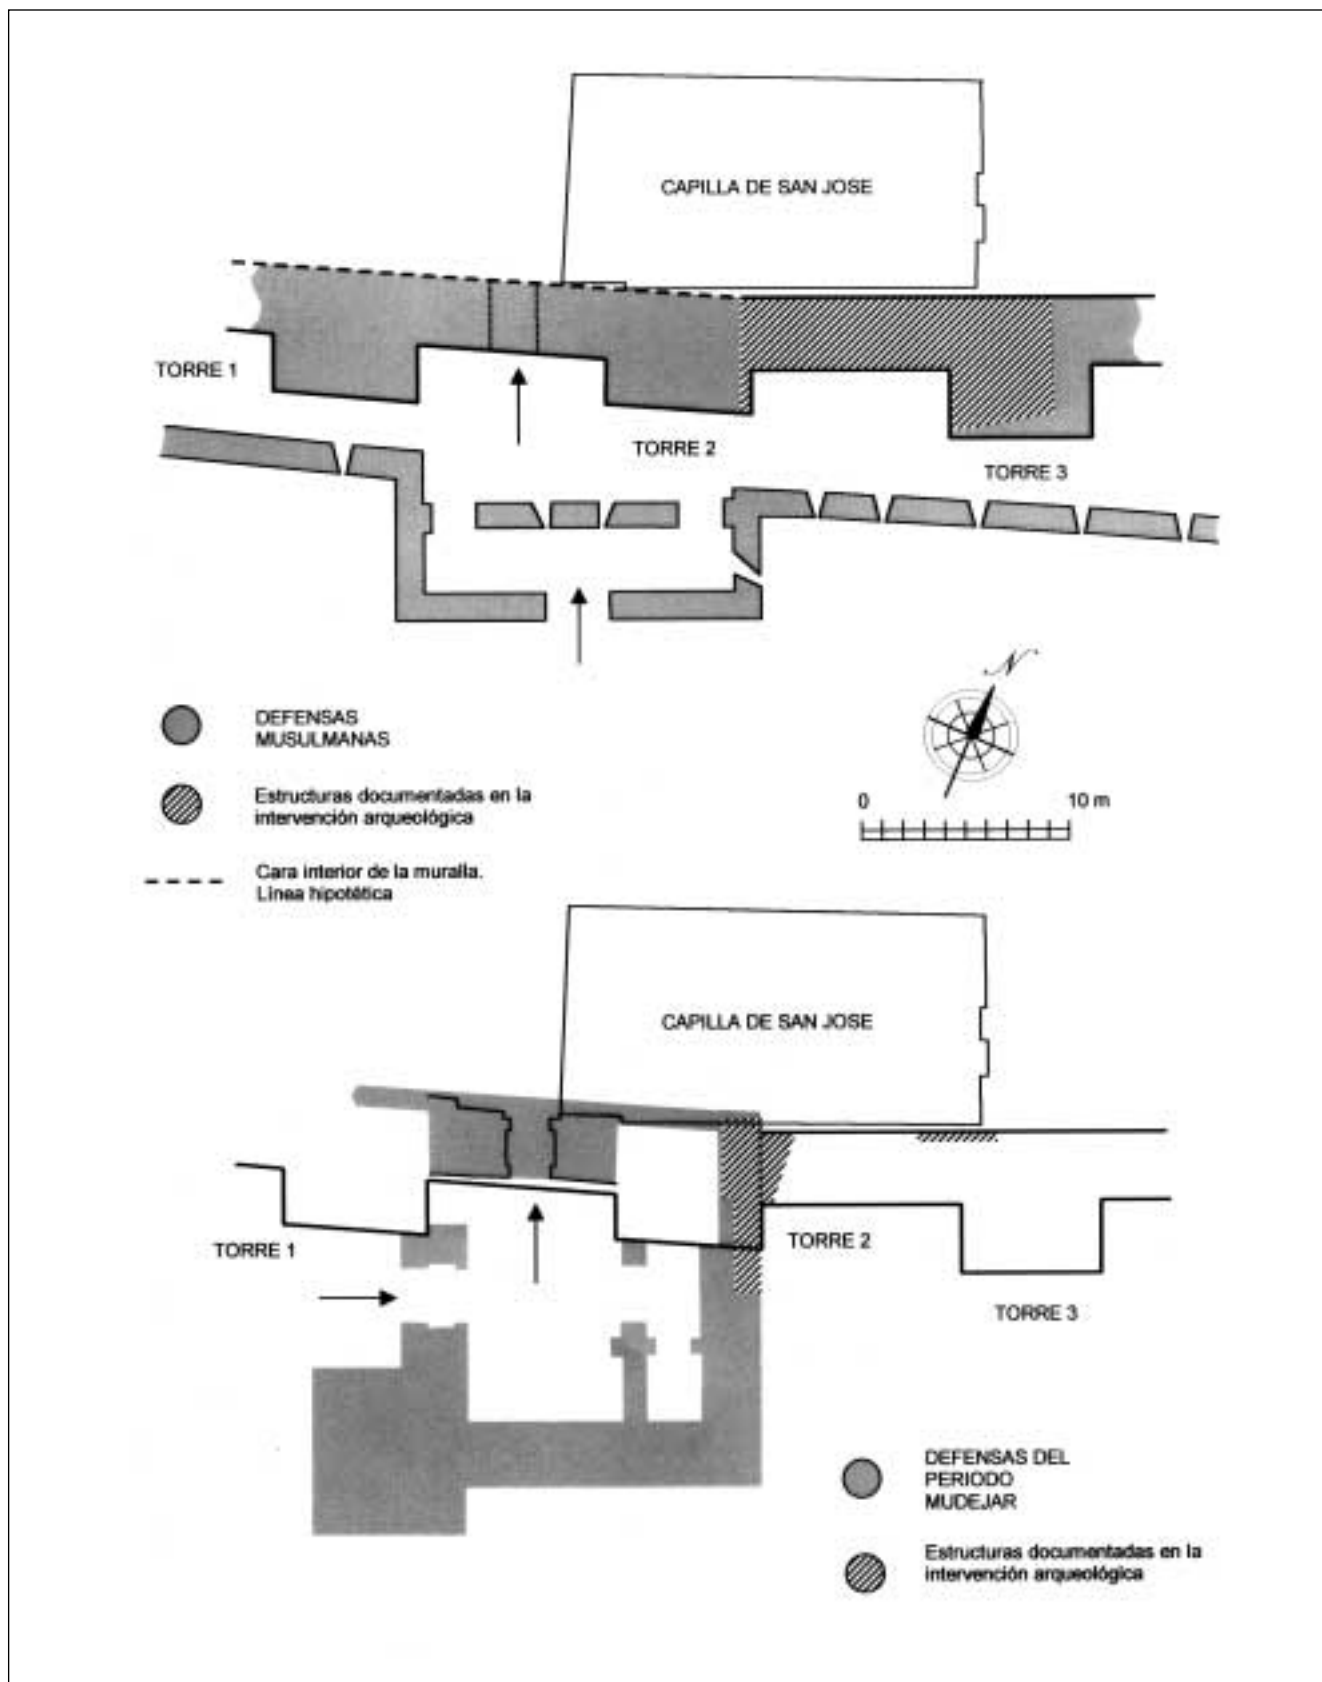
Planta de la Puerta de Santa Eulalia y tramo de la Capilla de San José (Sobre plano de M. Jorge Aragoneses).
